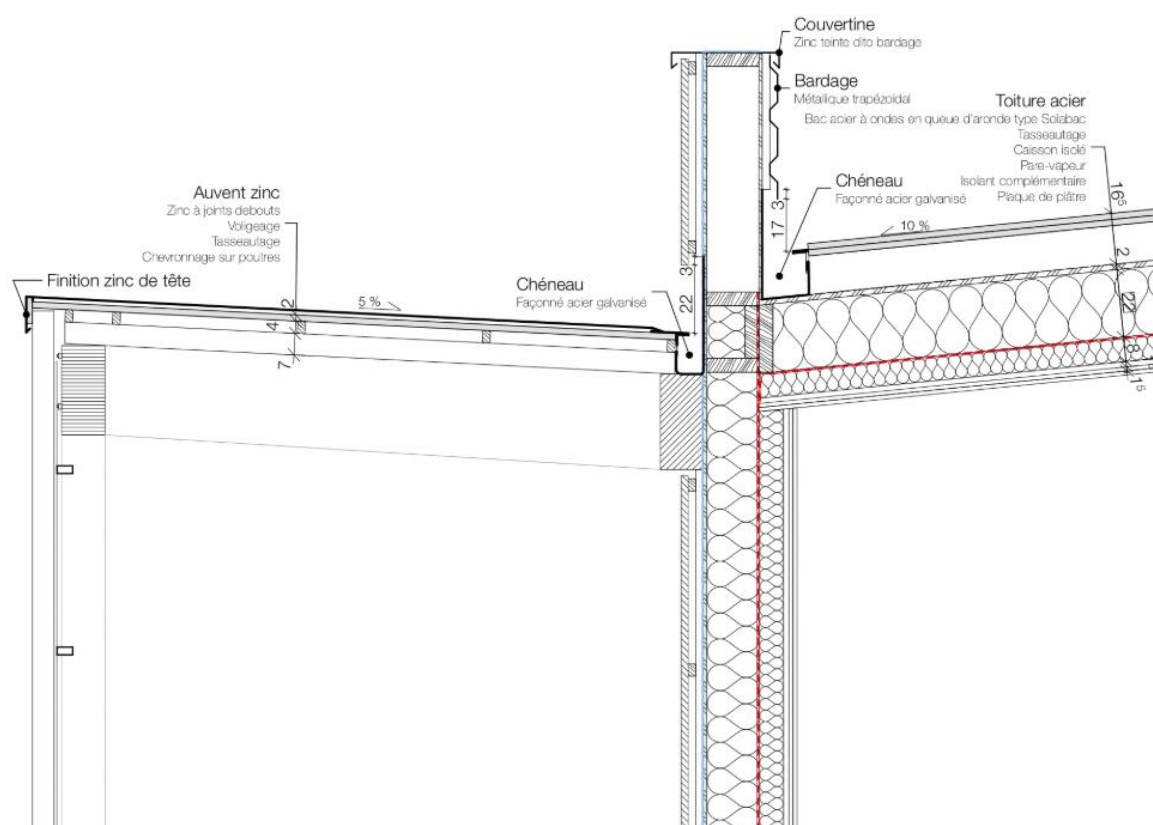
Coupe de détail sur la façade Nord : la coursive et toiture du cas d'étude (Leroy, 2021)
